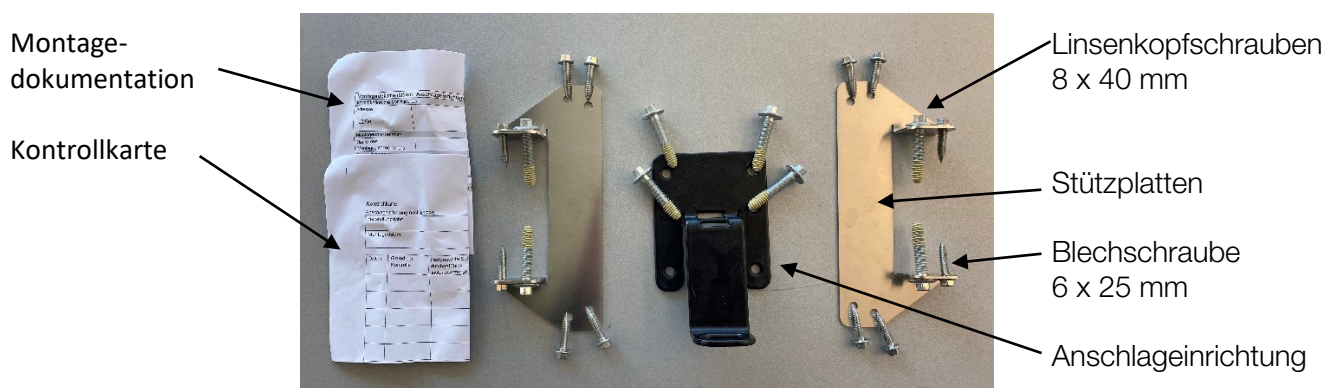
Set der Anschlagereinrichtung für Aluminium UK
